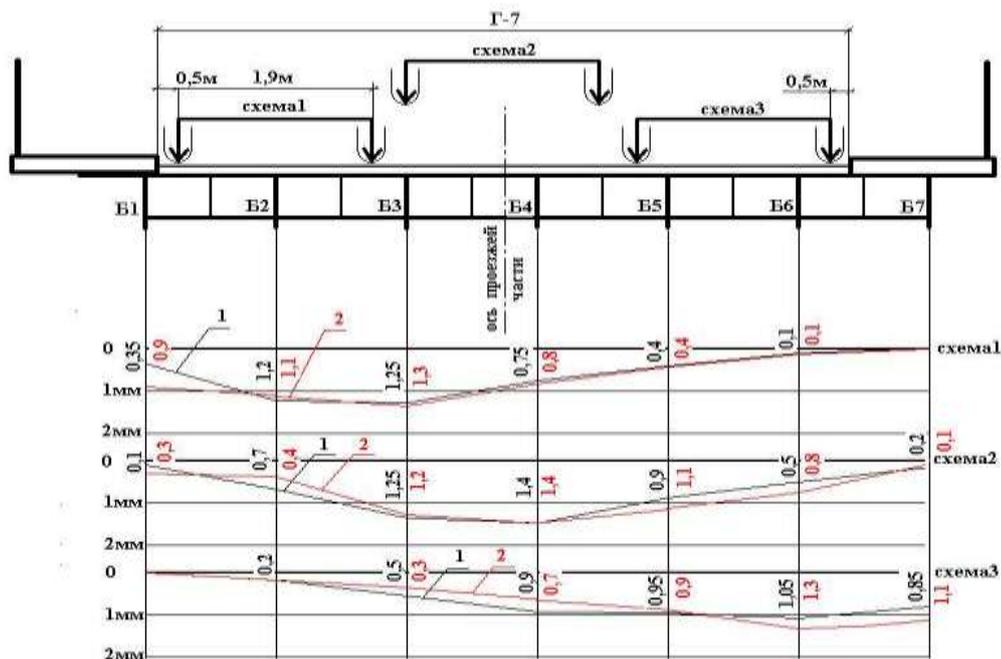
Эпюры прогибов балок от испытательной нагрузки.
